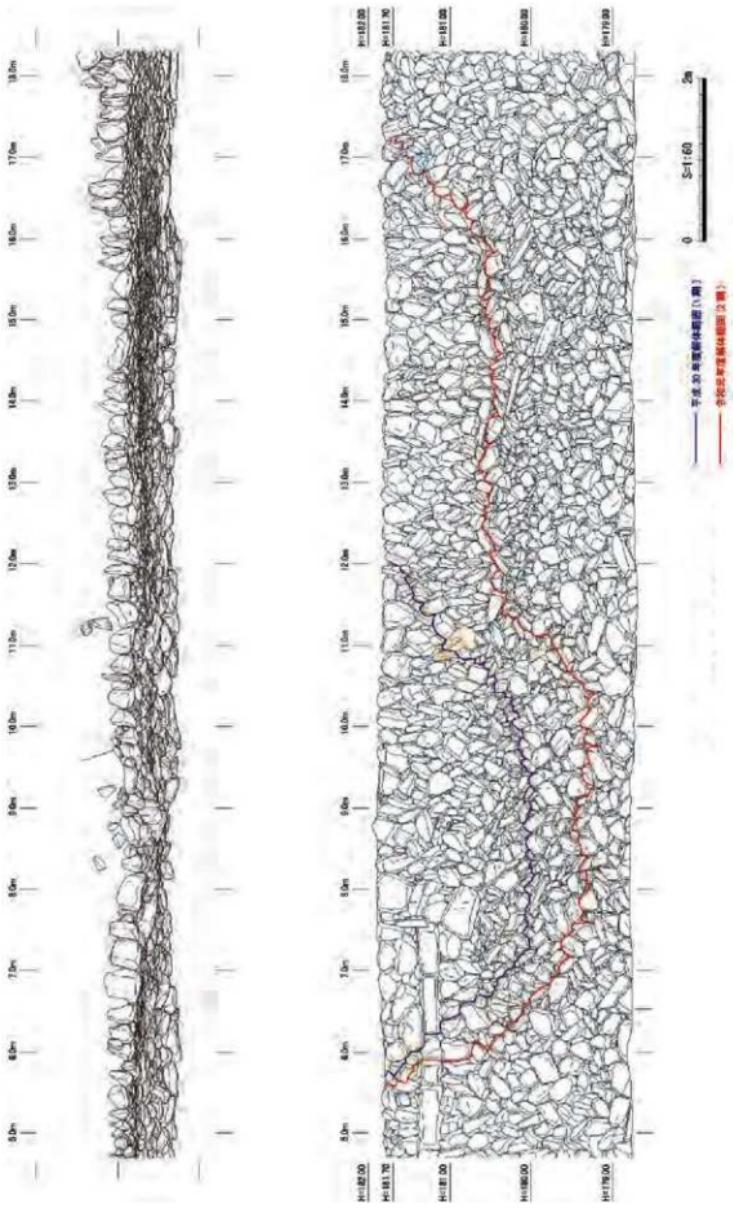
石垣 A 立面图 解体修理範囲（全体）
